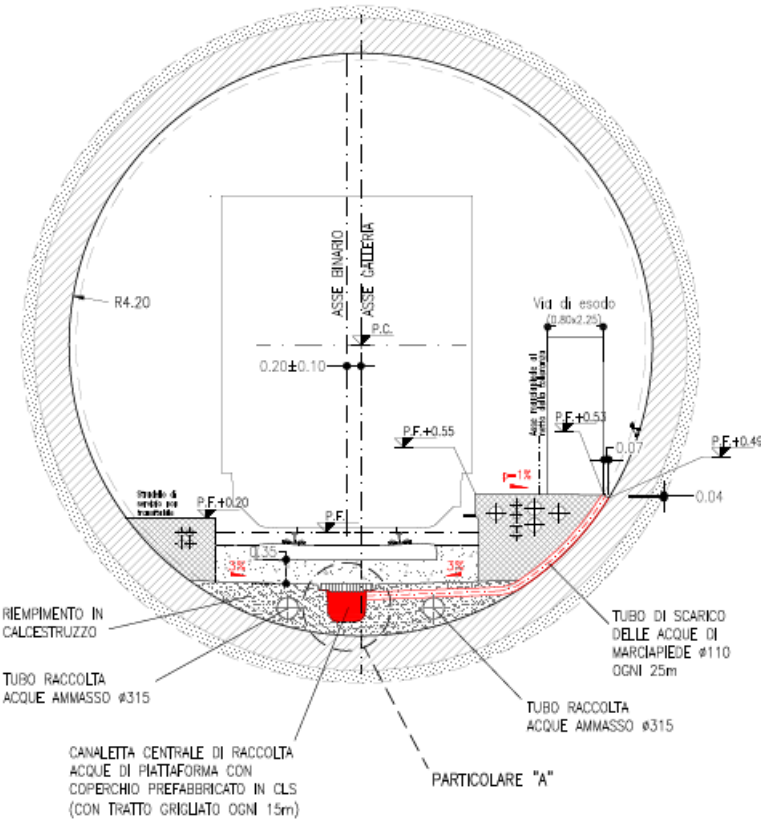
Sezione trasversale tratta in meccanizzato – Collettamento acque piattaforma – Sezione corrente
